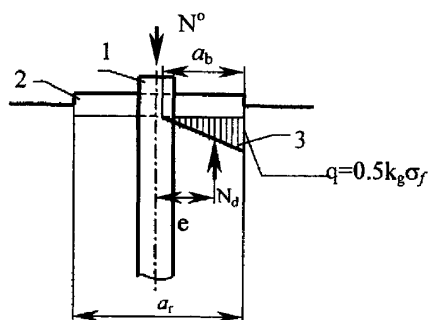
Расчетная схема фундамента с ростверком:
